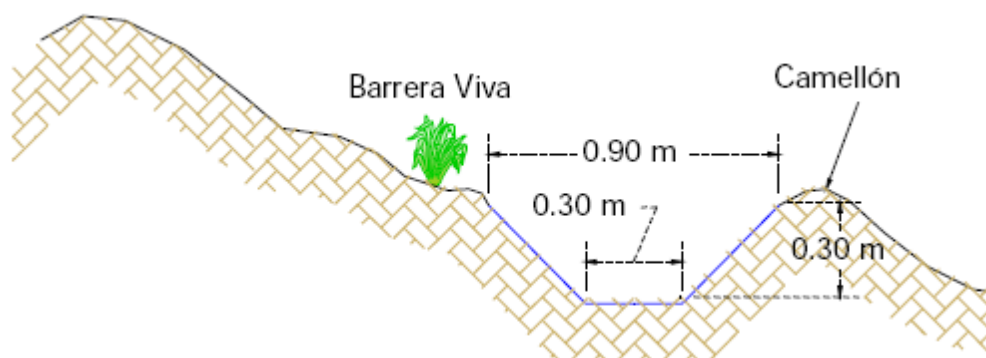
Dimensiones de la zanja de infiltración
